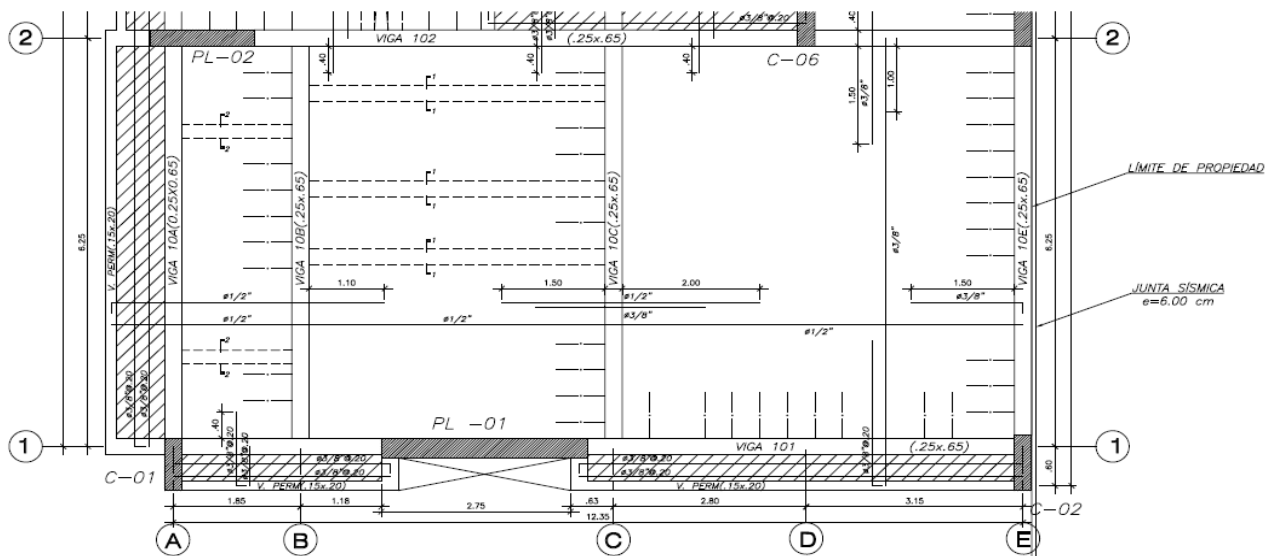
Armado de losa aligerada entre los ejes 1 y 2
